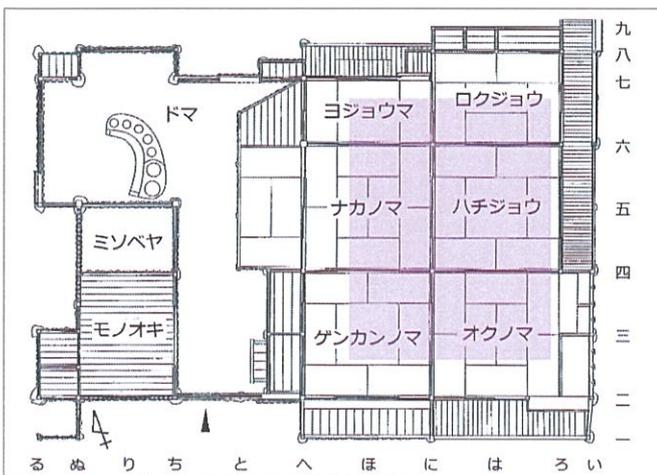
堀家住宅現状平面図 推定前身建物の広さ（桃色）
